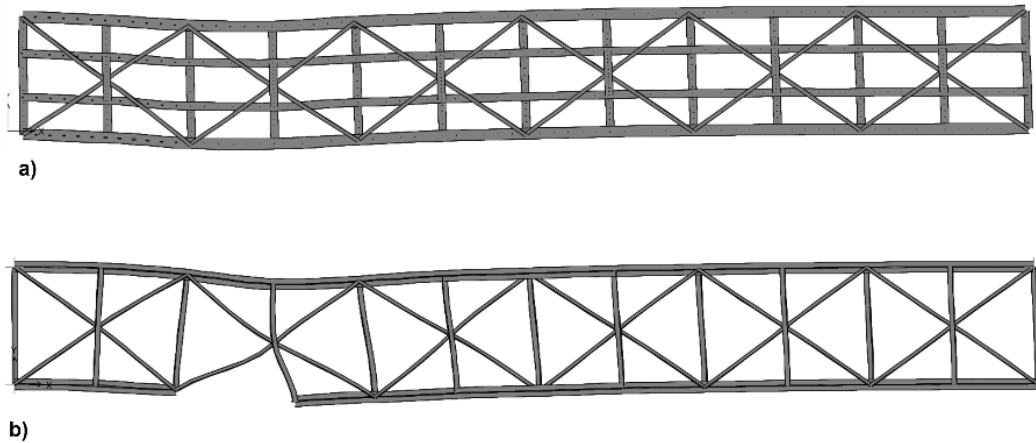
Flexión global fuera del plano a) planta superior y b) planta inferior
